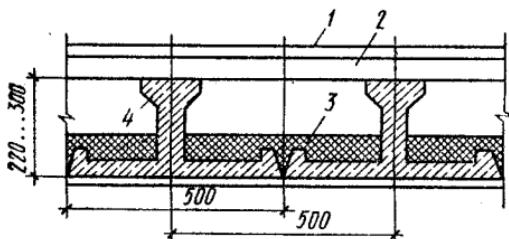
Конструкции для замены перекрытий с железобетонными балками-настилами двутаврового сечения:
